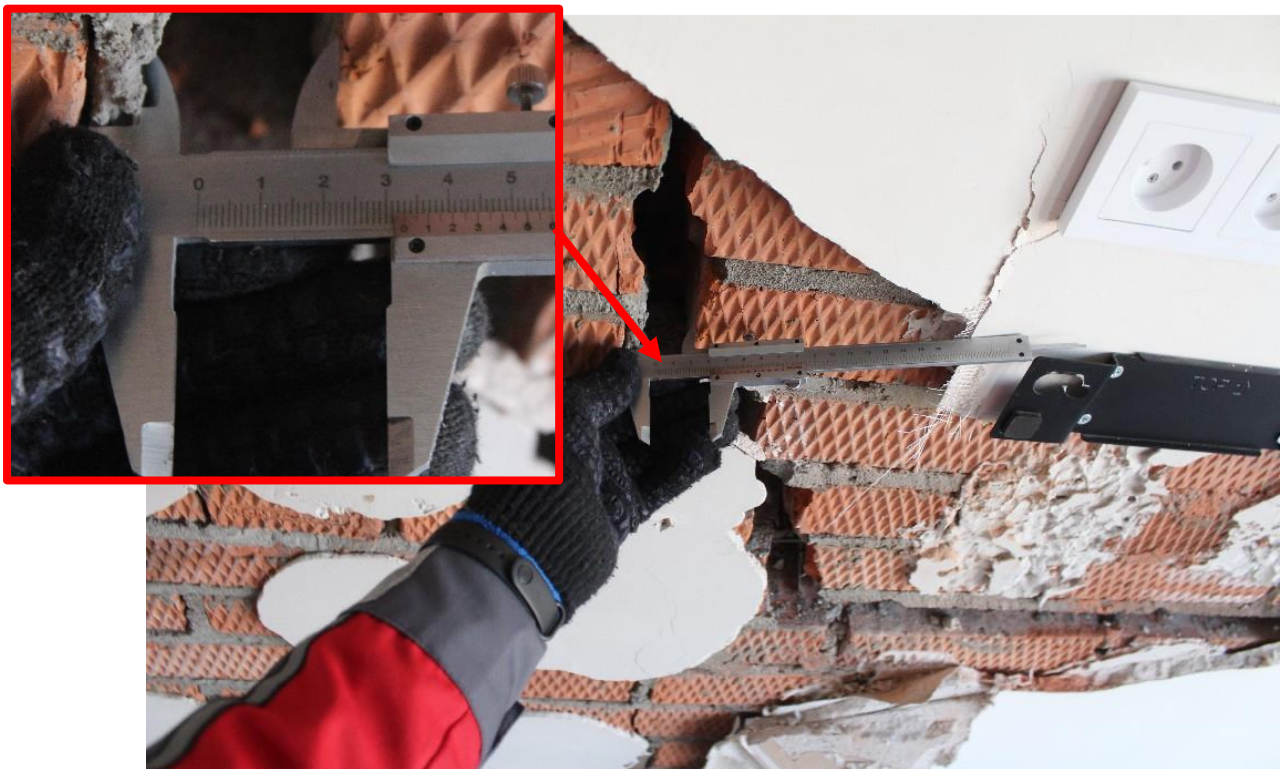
Трещина по вертикальному шву кладки с шириной раскрытия 33 мм
